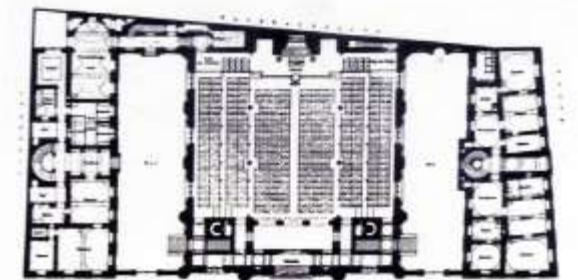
Grundriss Synagoge Wien
